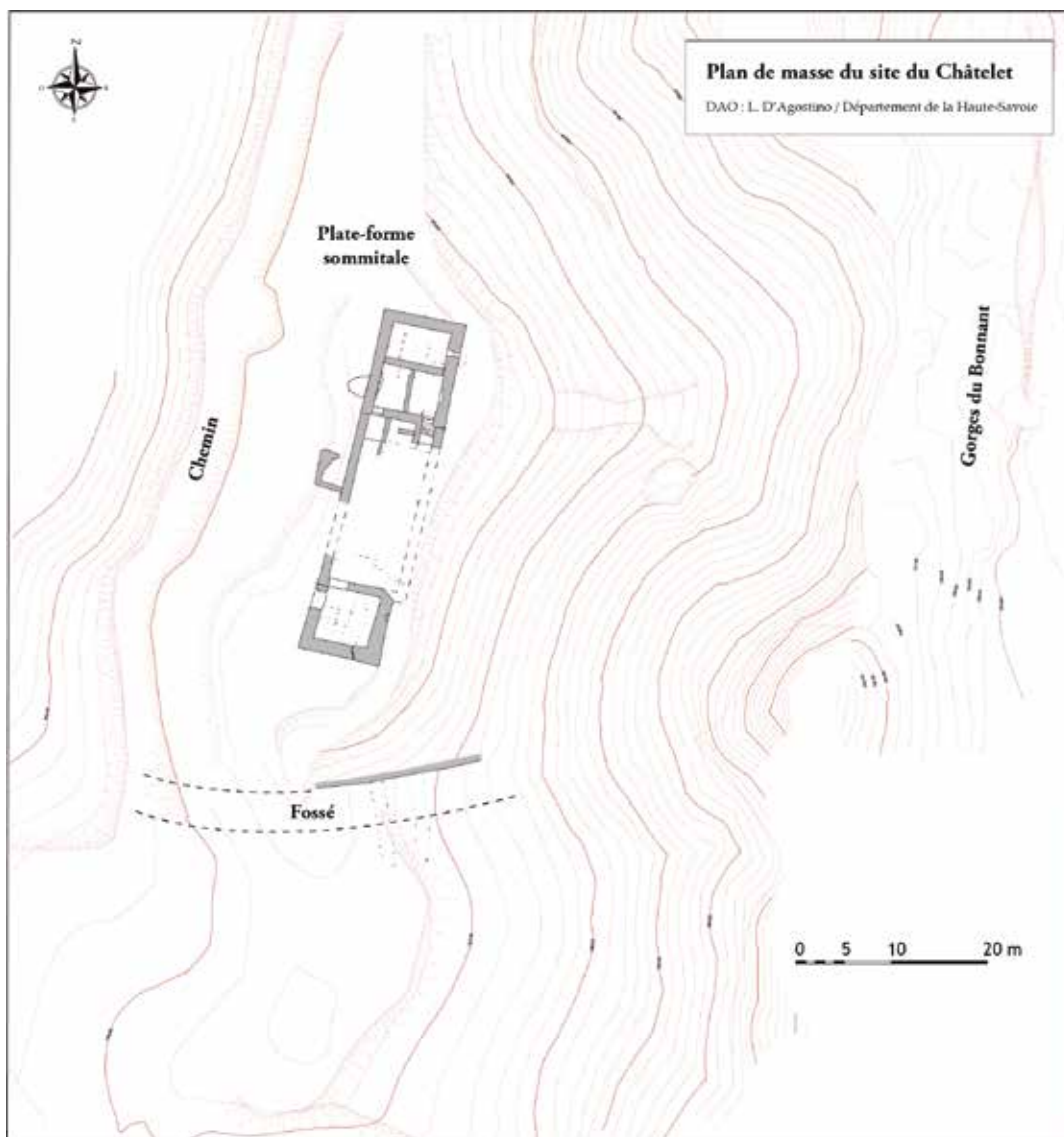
Plan de masse du site du Châtelet © L. D'Agostino.
